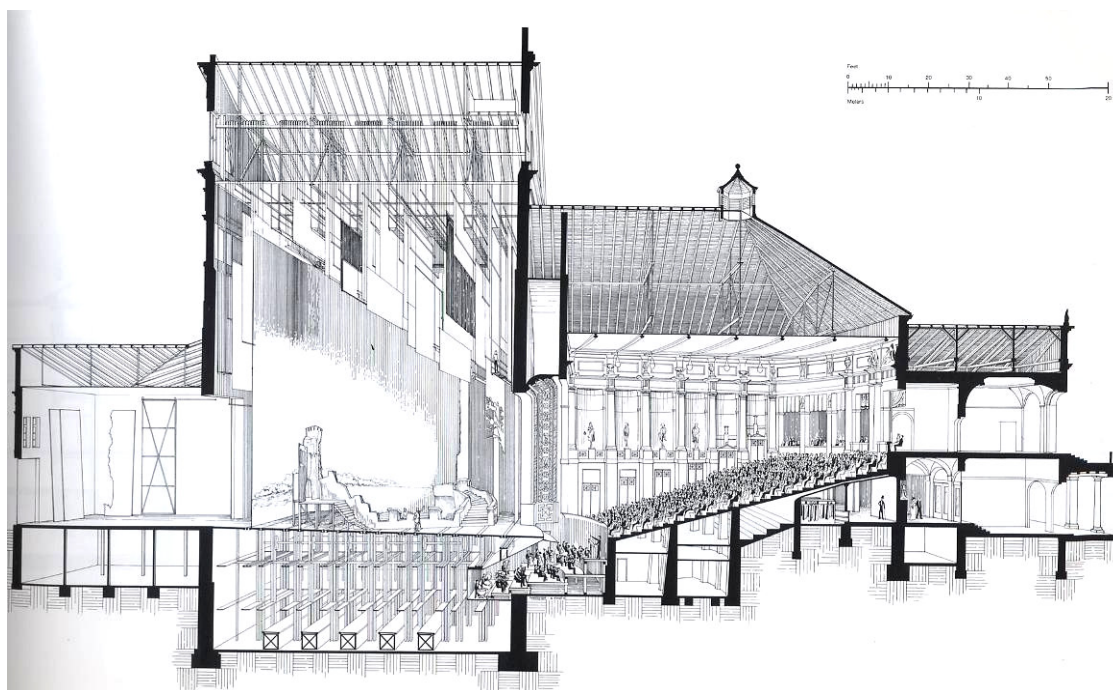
Prinzregenten Theater sezione longitudinale prospettica e pianta.
